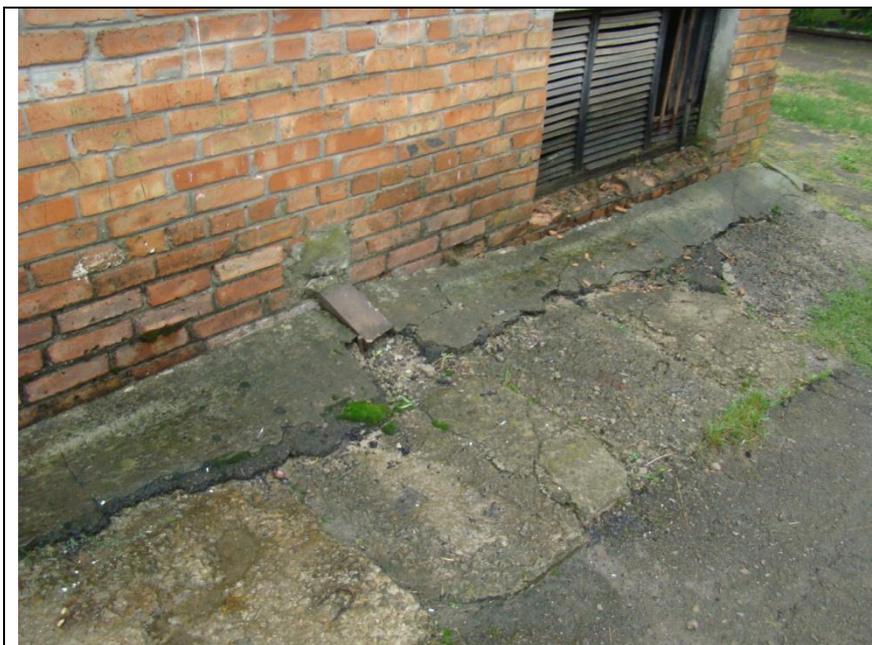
9 – Физический износ конструкций здания – трещины в основании и на фасадах
